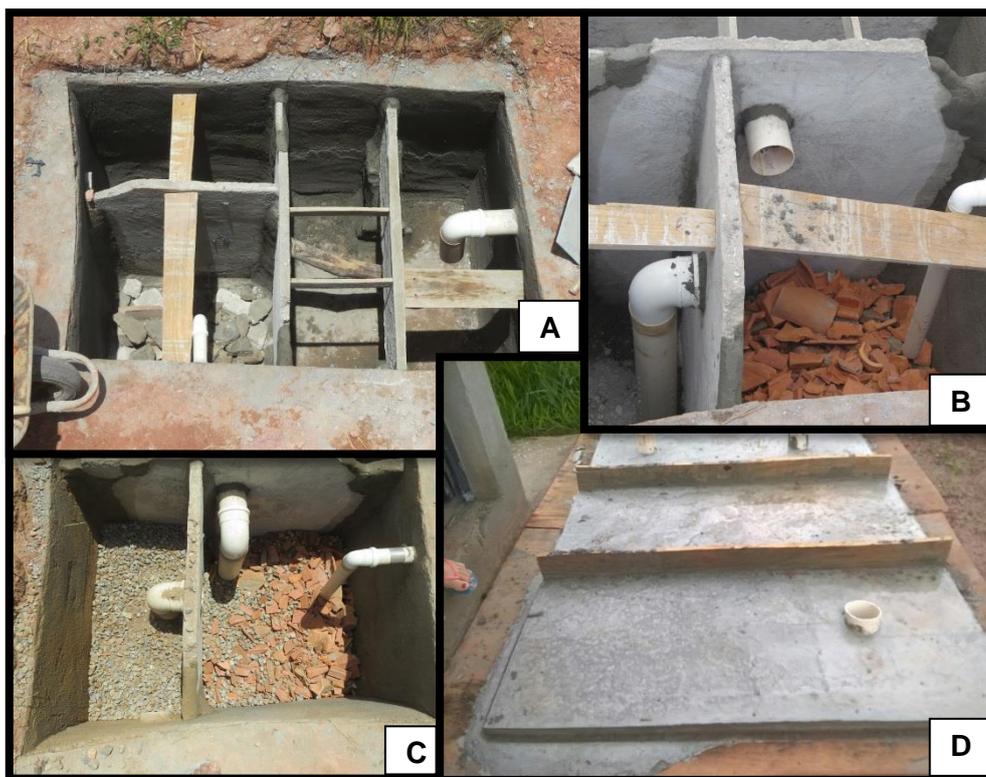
Disposição das divisões, instalação hidráulica, preenchimento dos filtros e construção das tampas do sistema de tratamento de efluentes.
